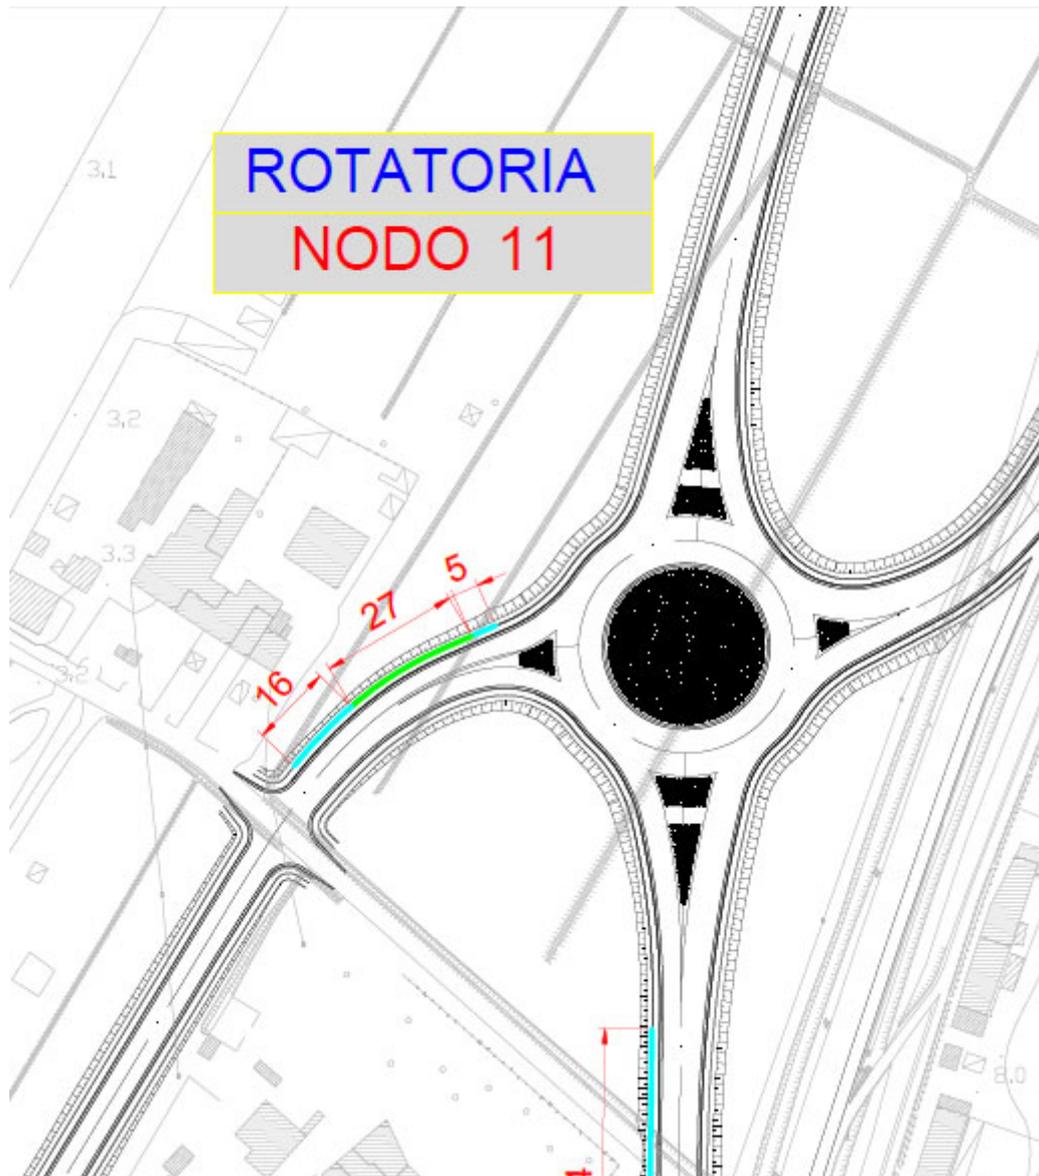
Planimetria barriere acustiche nodo 11 (lotto 10-12)
